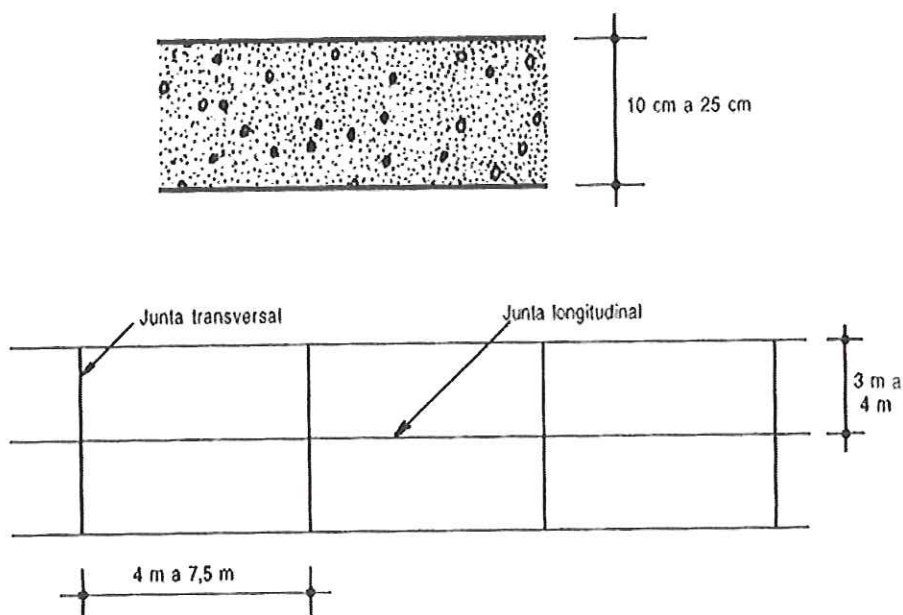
Pavimento de concreto simples (Carvalho e Pitta, 1996)
